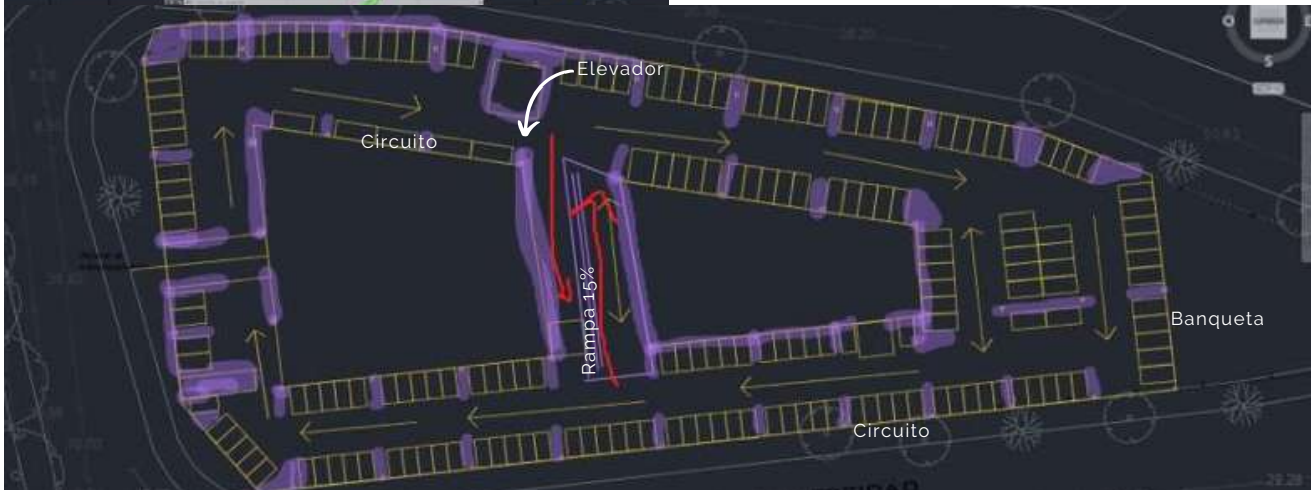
Planta arquitectónica sótano. Estacionamiento. Fuente: Autoría propia
